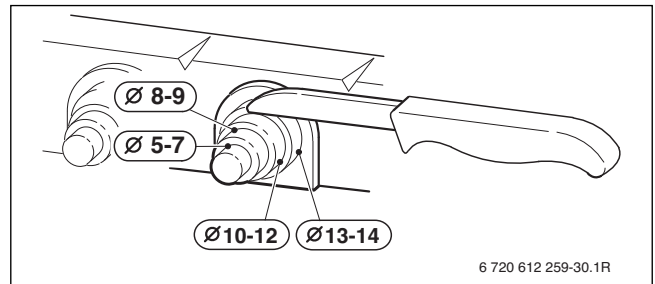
Zugentlastung an Kabeldurchmesser anpassen
